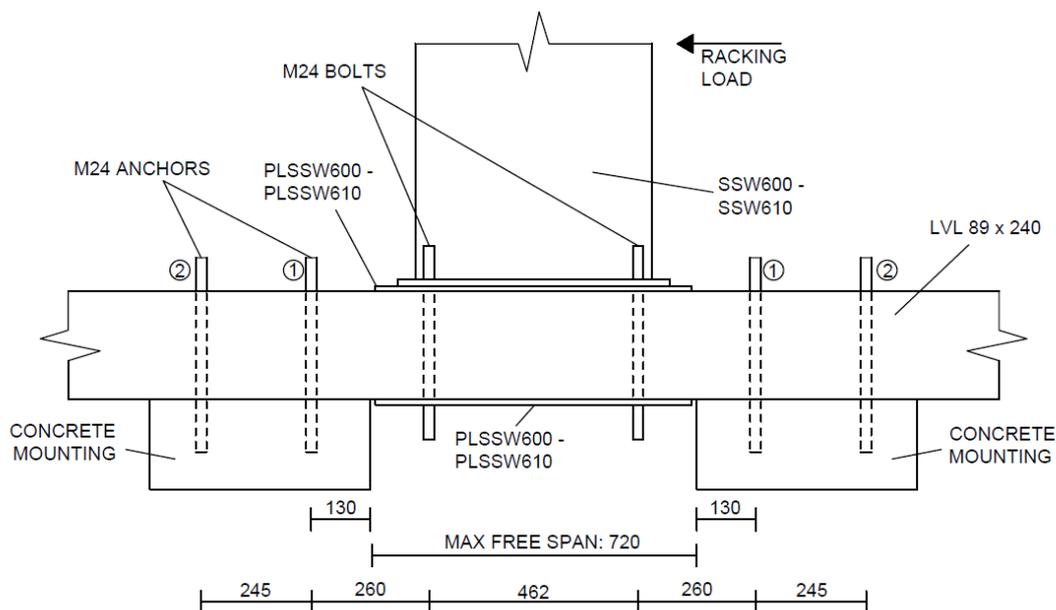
Détails d'installation du Steel Strong Wall™ sur support bois
